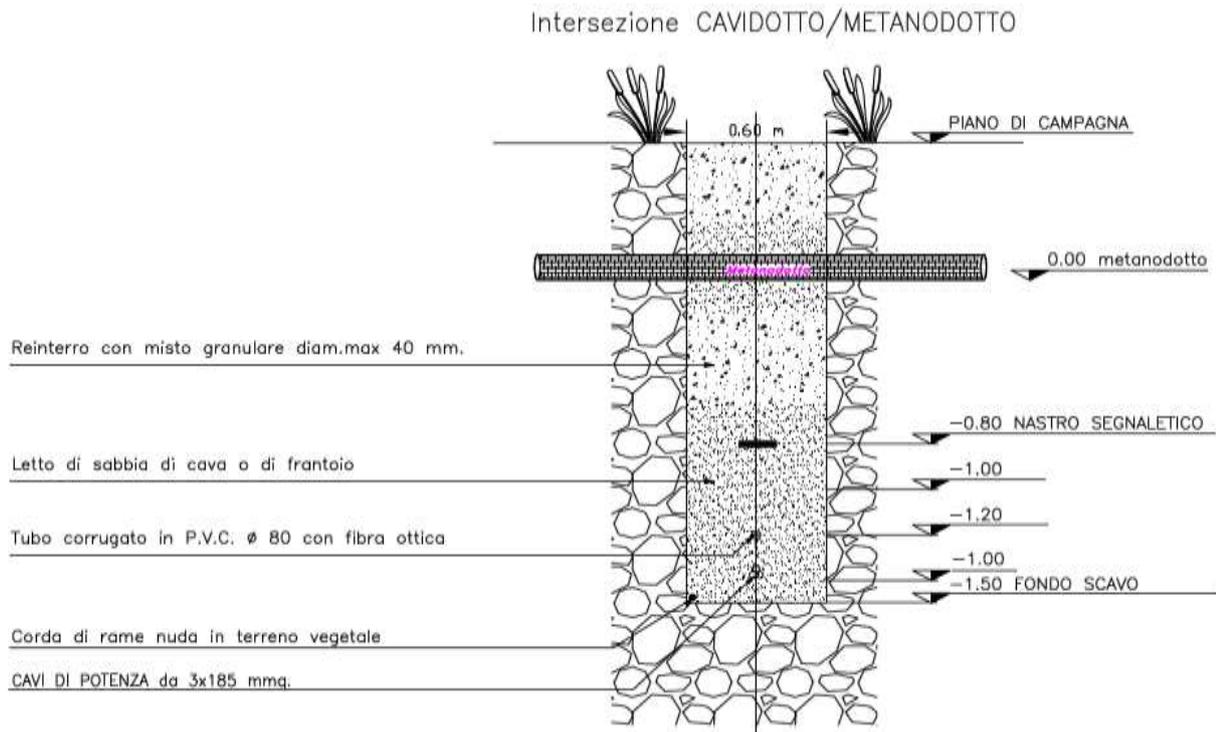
Tipico Cavidotto- intersezione con metanodotto
